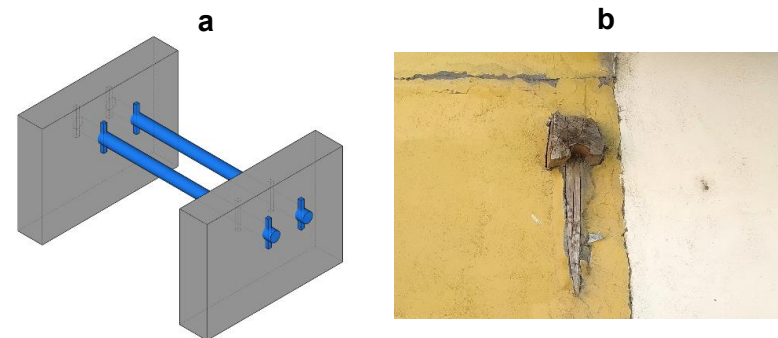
a) Esquema dispositivo DP; b) Fotografía dispositivo DP. Fuente: Archivo y elaboración propia.
